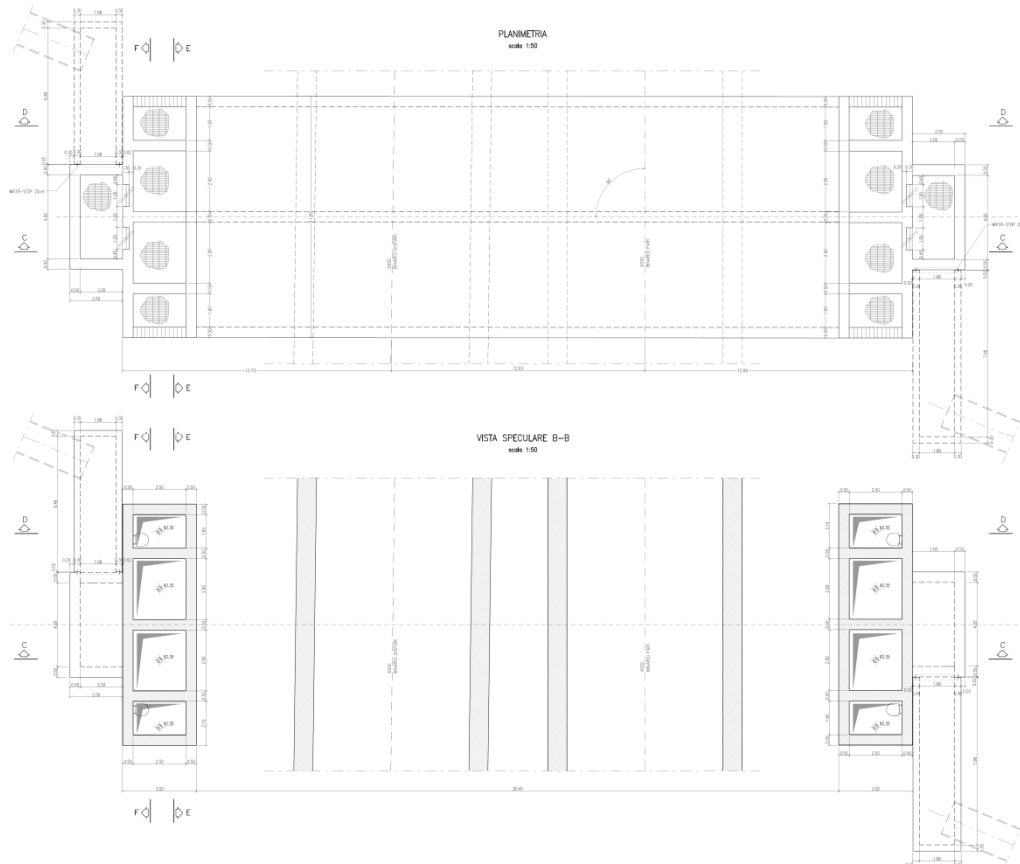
Carpenteria sifone: vista dall'alto e sezione superiore
